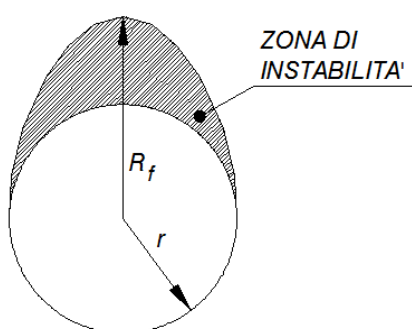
Illustrazione del fenomeno di spalling
